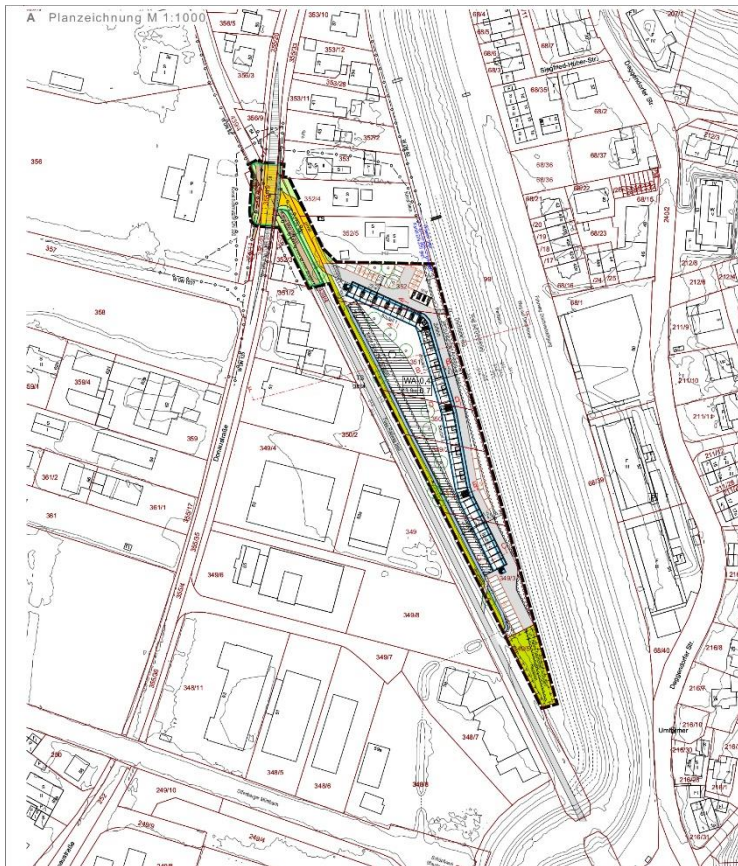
Bebauungsplan (G+2S, Stand 02.10.2023)
